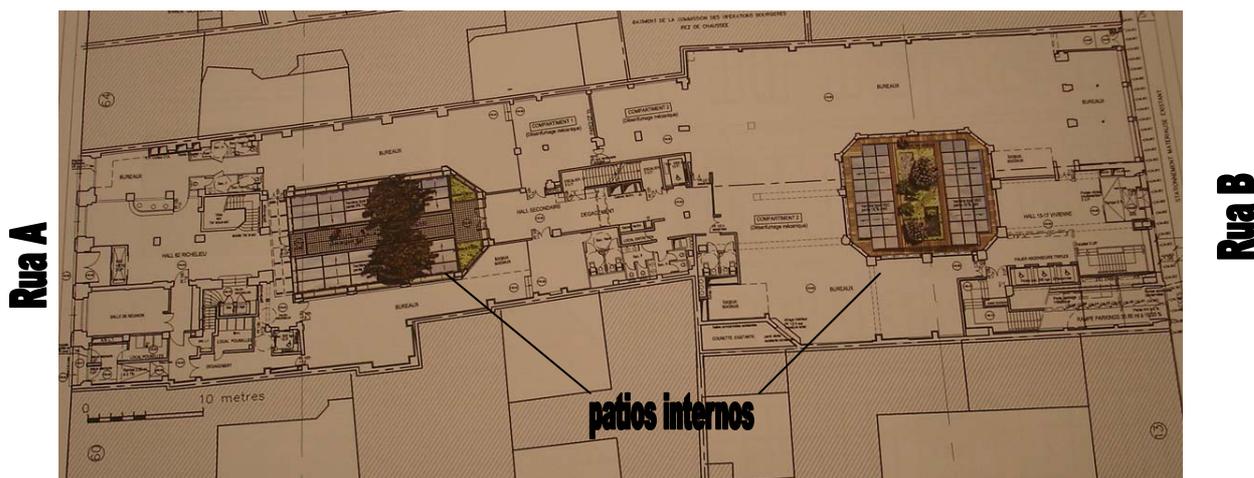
Planta do empreendimento estudo de caso (anteprojeto definitivo)
